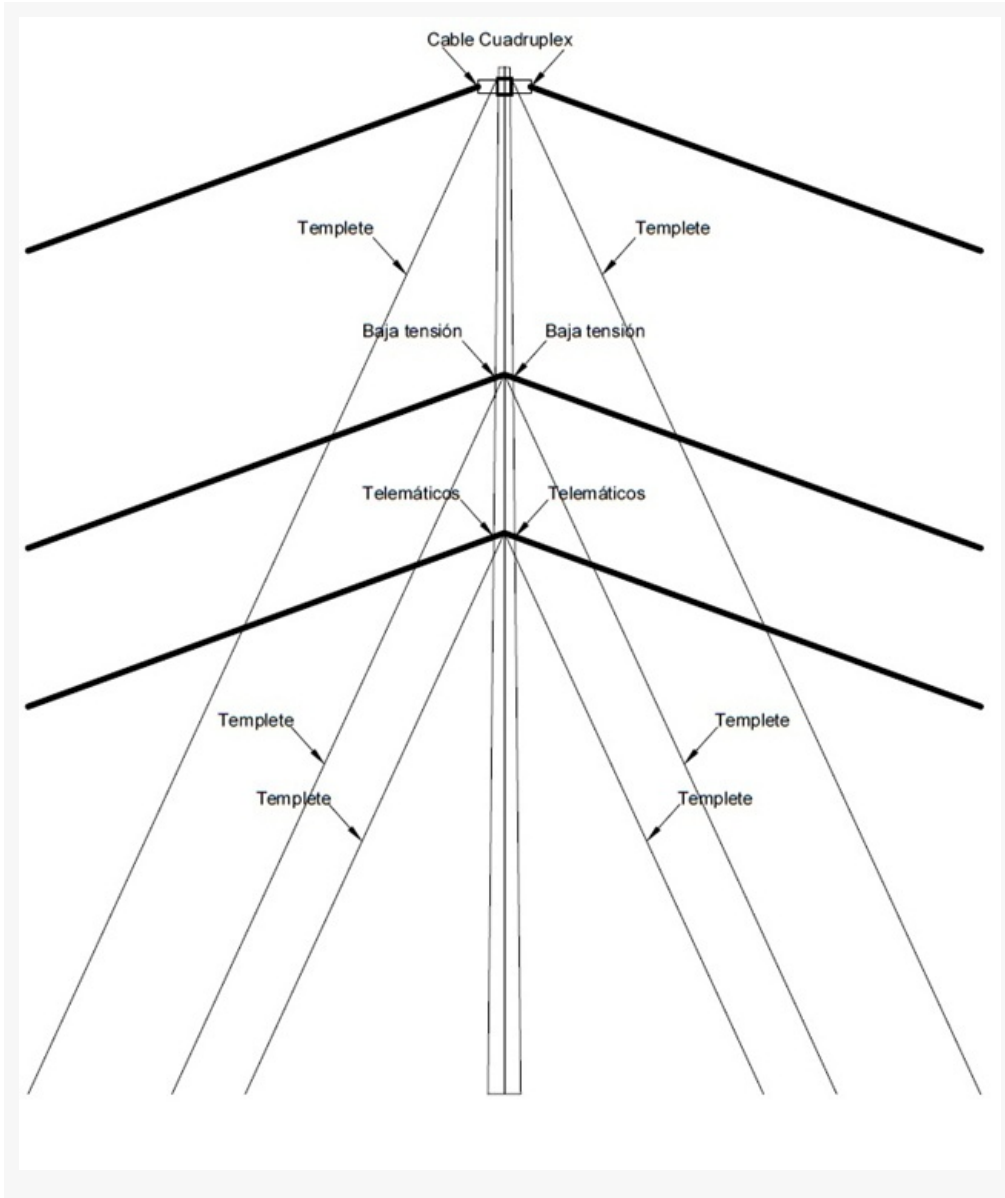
Vista frontal poste de estructura retención-ángulo disposición cables de M.T, B.T y Telemático, con postes hasta 1350kgf.
